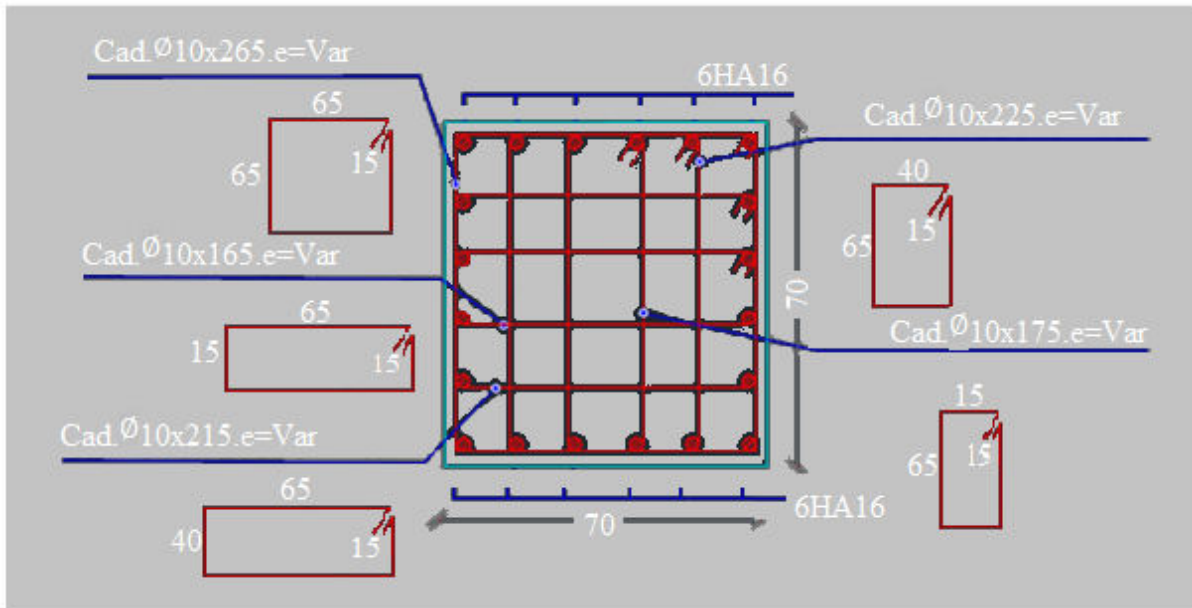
Coupe de ferrailage des poteaux 70×70 cm<sup>2</sup>
